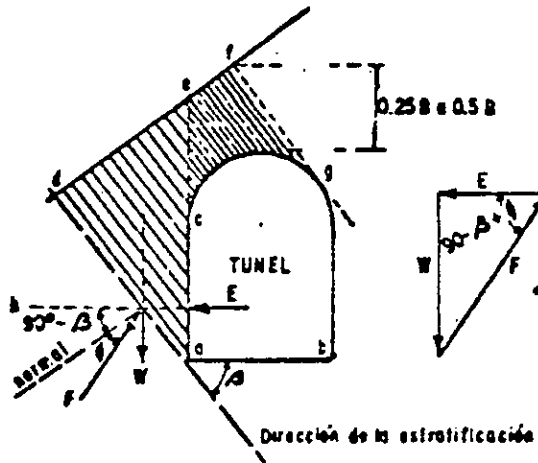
Cálculo de empujes en roca estratificada en planos inclinados
